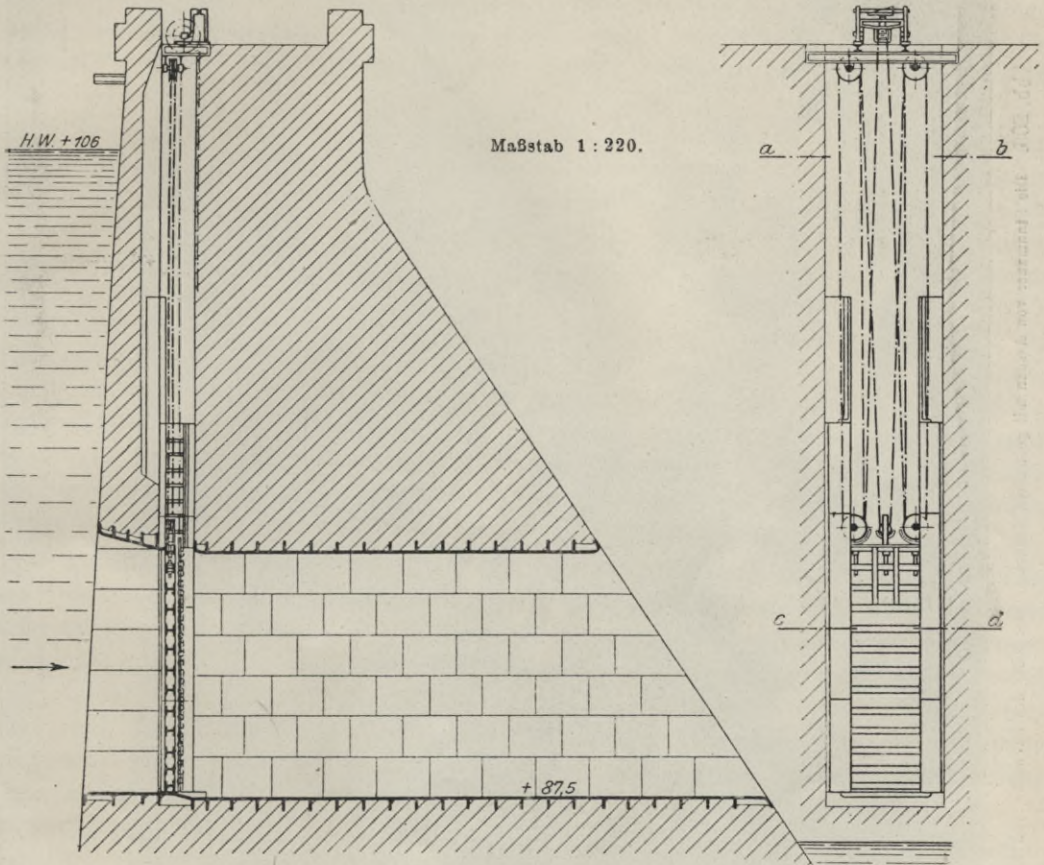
Grundablaß an der Staumauer bei Assuan. Vgl. auch Abb. 224.
